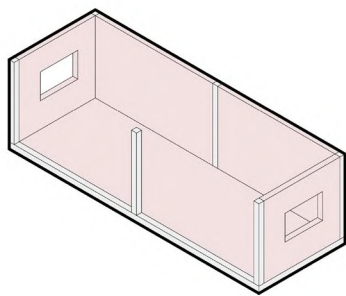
Stahlbeton-Modul, reduziert auf das tragende Skelett, mit leichten raumabschließenden Bauteilen
